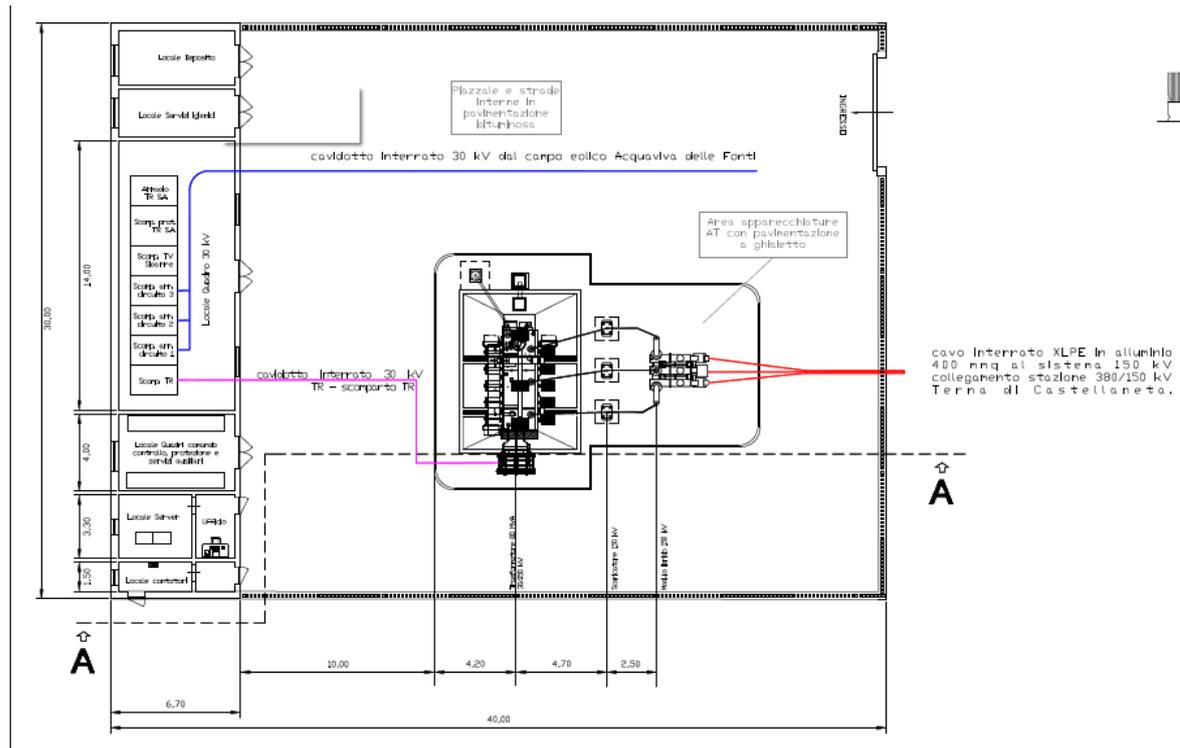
Planimetria stazione di trasformazione 30/150 kV
